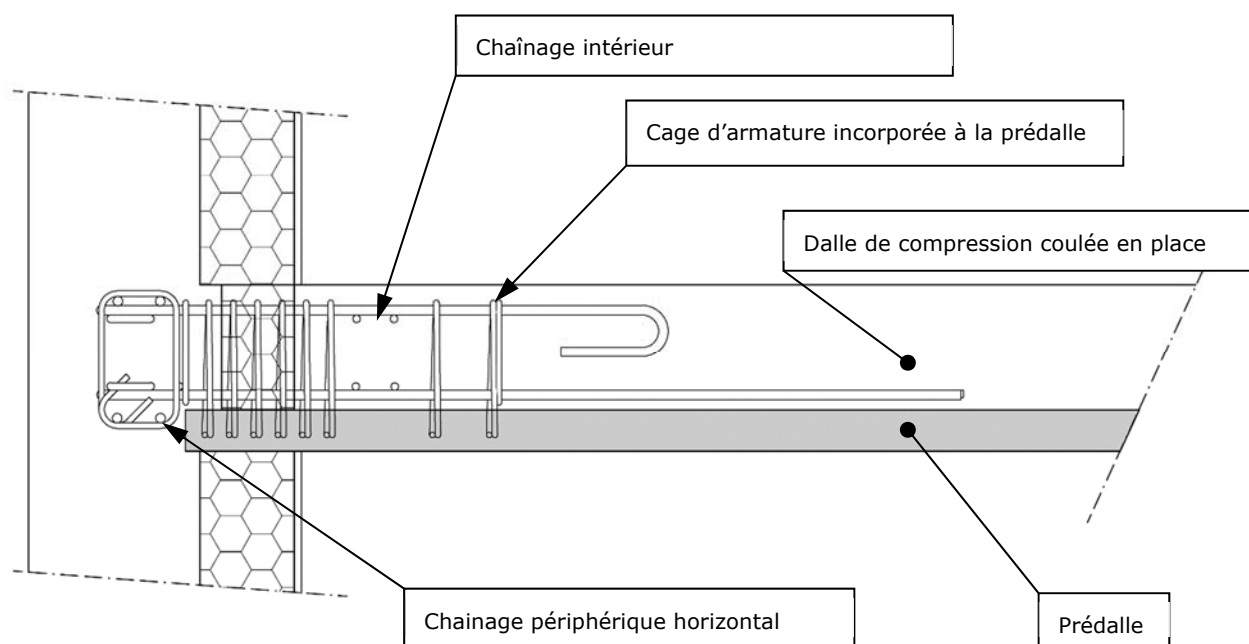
Détail de liaison voile-plancher avec panier de type A
